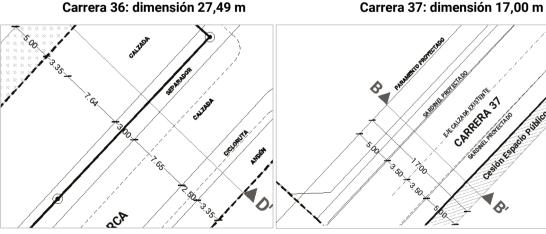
Dimensión de las carreras 36 y 37 Fuente: elaboración propia
